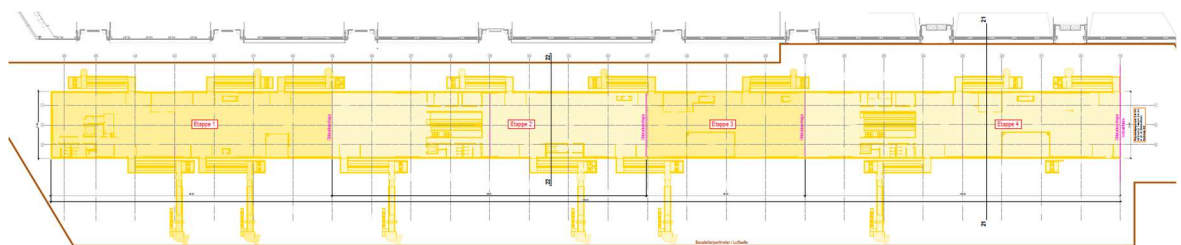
Umschlossener Bauperimeter Luftseite inkl. Etappierung Rückbau
